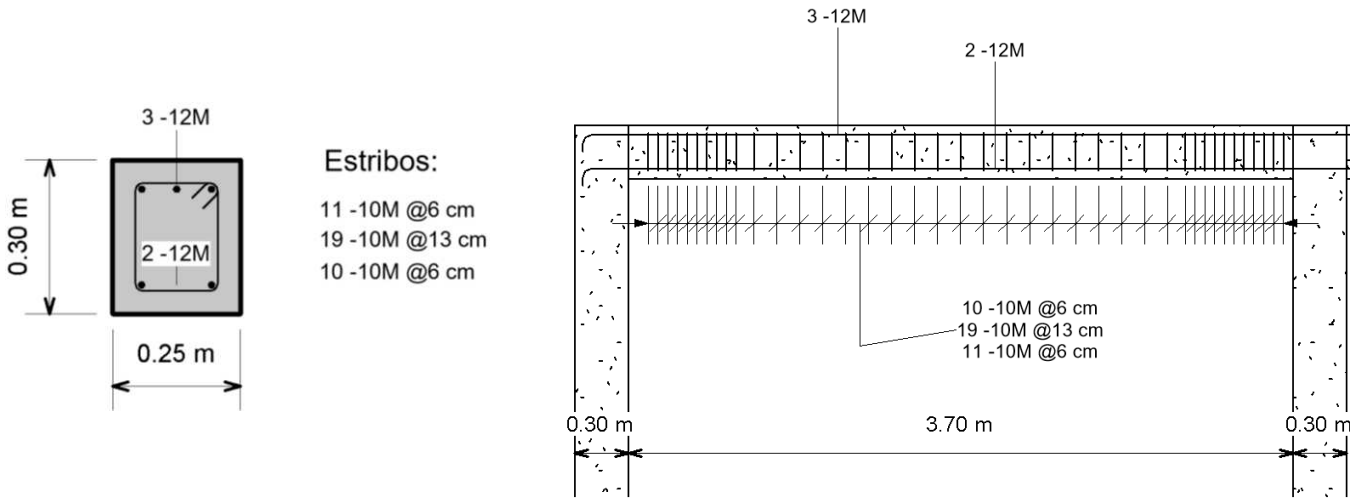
Dimensiones de la sección transversal y del refuerzo colocado en la viga 1 OMF del sistema de 3 pisos
